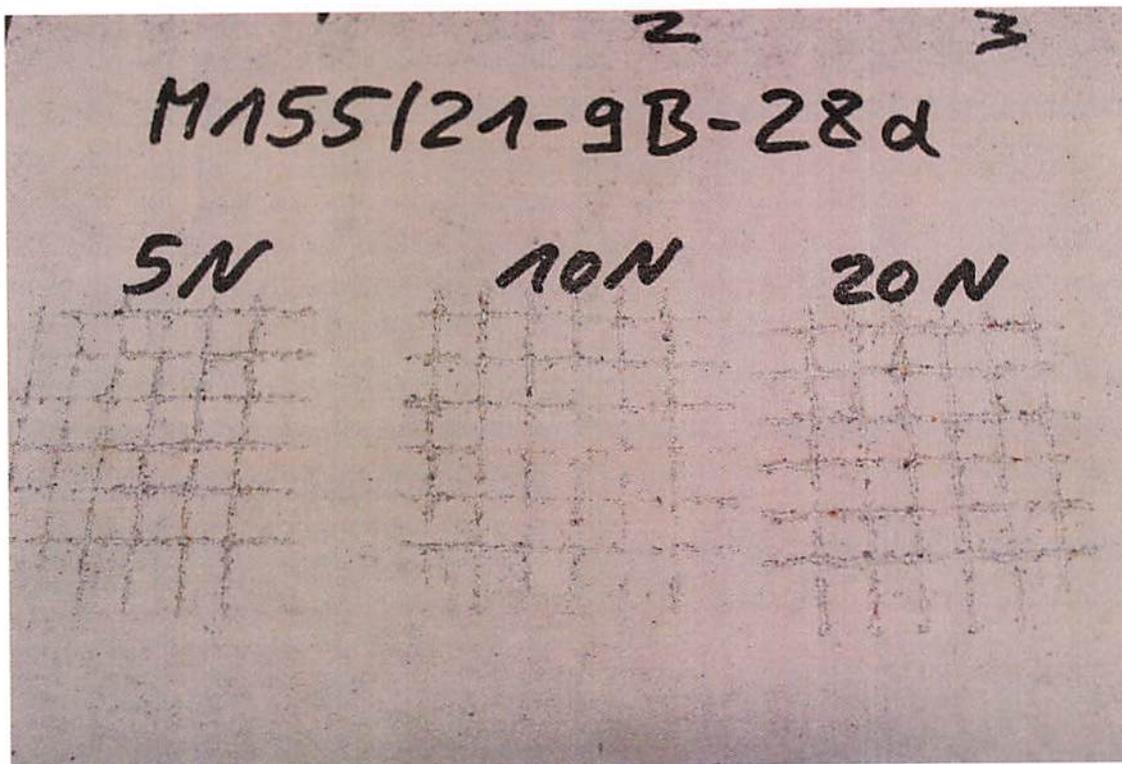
Ritzbilder Estrichoberfläche mit Zement Z15 - Lagerung B / Prüfalter 28 Tage
